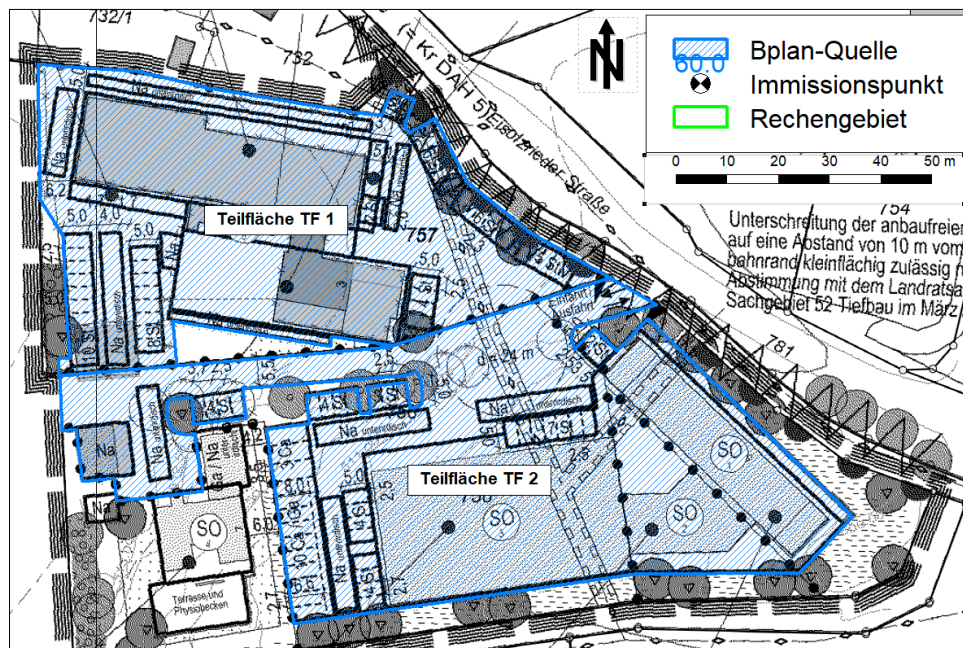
Lageplan Teilflächen TF1 und TF2, Katastergrundlage gemäß [3].
